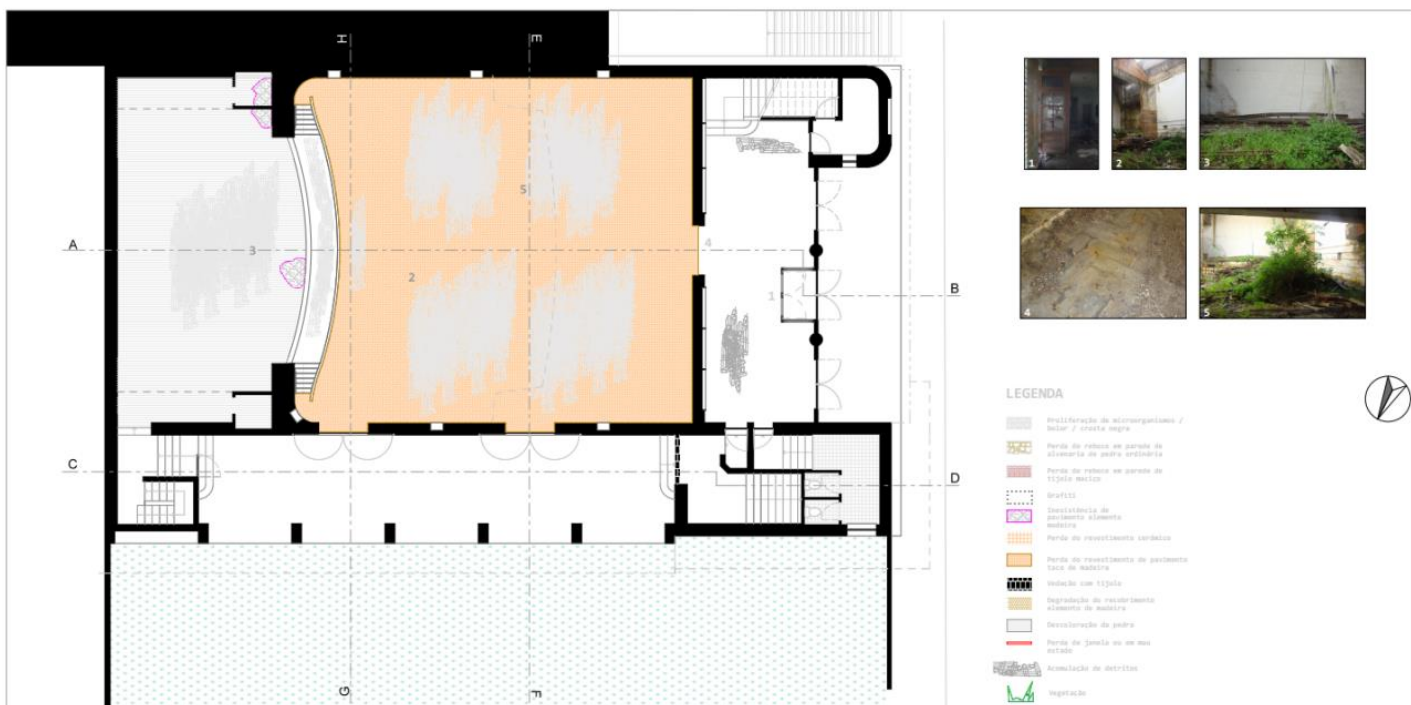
Estado Conservação Planta Piso 0, Pedro Santos 2017
